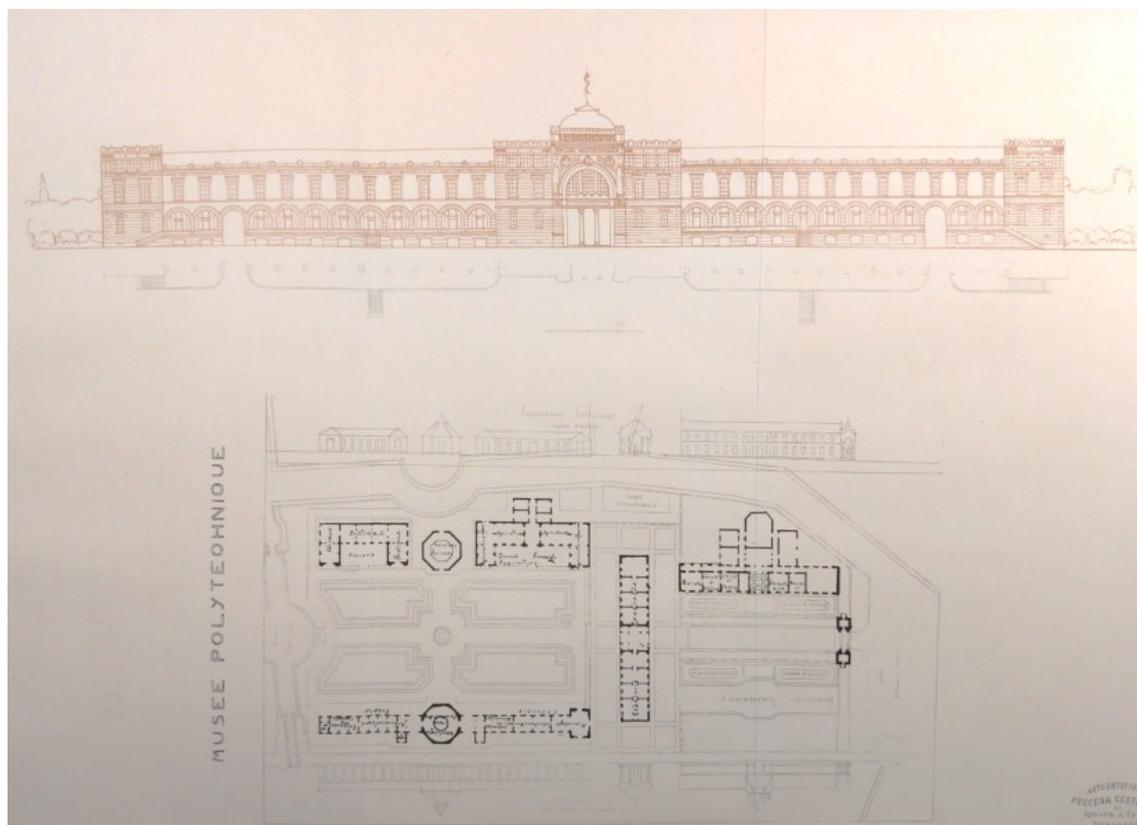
Музей прикладных знаний. Вверху: фасад для здания музея на Лубянской площади. Внизу: план павильонов в первом Александровском саду. План. Арх. Э. Трела. 1874 год.
